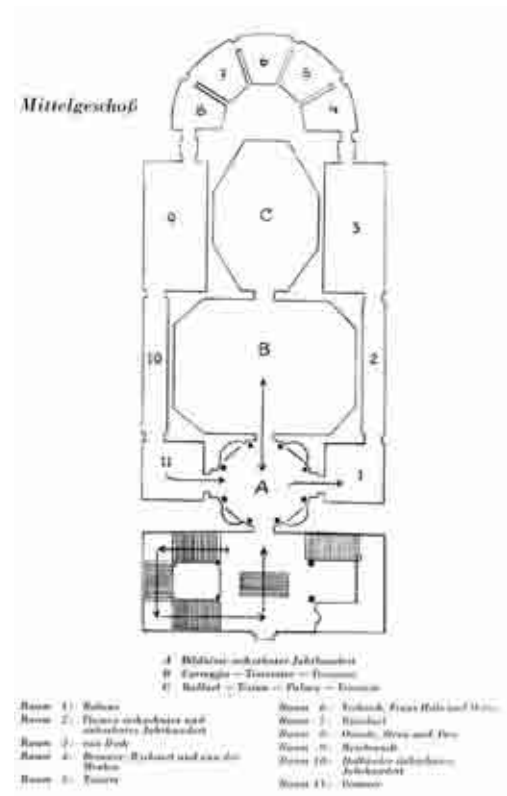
(#238) Grundriss der Ausstellung *Meisterwerke der Dresdner Galerie*; Berlin, Nationalgalerie, 1955. (Foto: TW)
